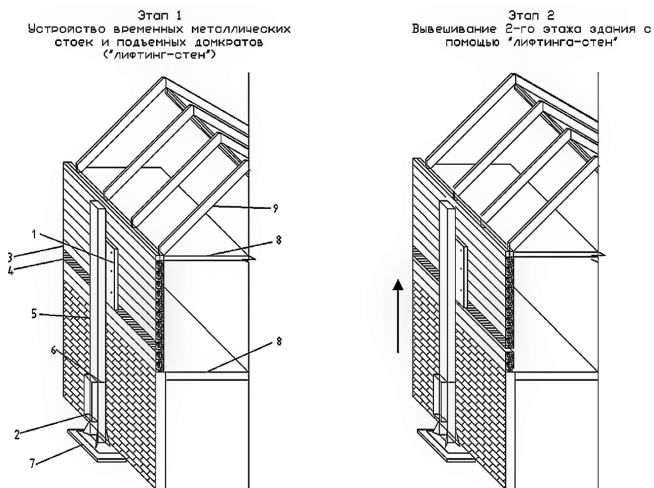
Этап № 1. Этап № 2. Замена поврежденных венцов бруса с помощью домкратов и стоек: 1-сжимы; 2-домкрат; 3-целый брус; 4-заменяемый брус (наклонная штриховка); 5- стойка; 6-опорная стойка; 7-бетонное основание на уплотненном грунте (Купл=0,98); 8- перекрытие; 9-стропильная система
